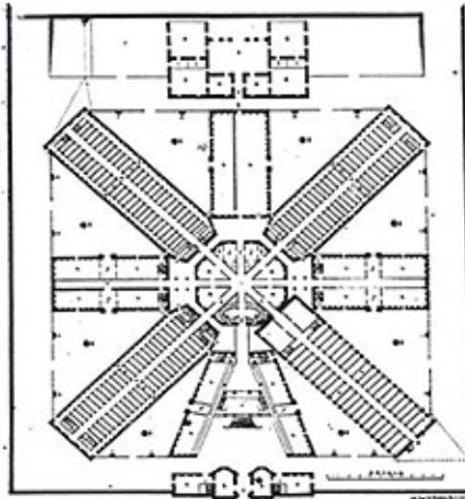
Planta da Casa de Correção da Corte, 1834. Fonte: Arquivo Nacional.
